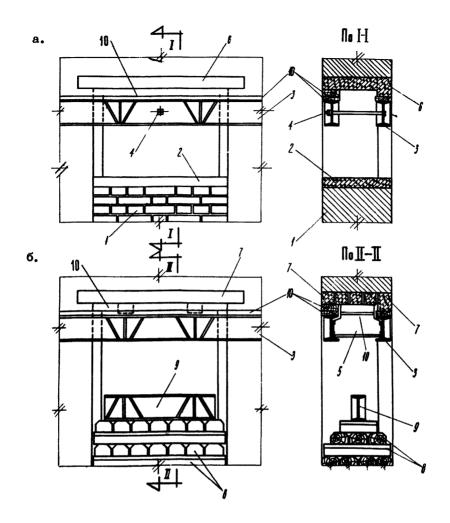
Схемы устройства домкратной ниши в оконном проеме подвала:
